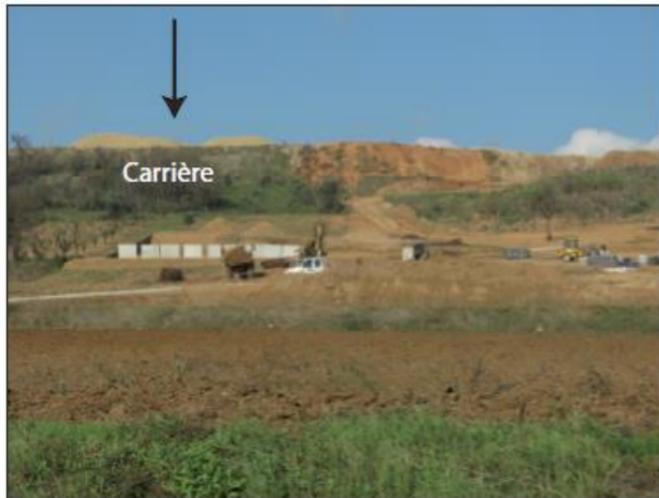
vue sur la carrière actuelle depuis la route de Saint-Gilles
